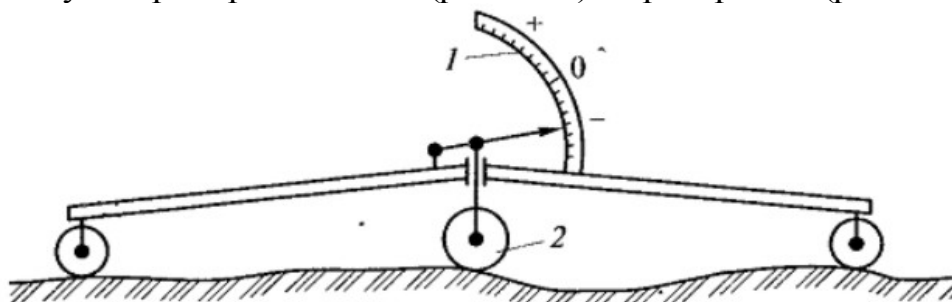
Передвижная двухопорная рейка ПКР-1:
